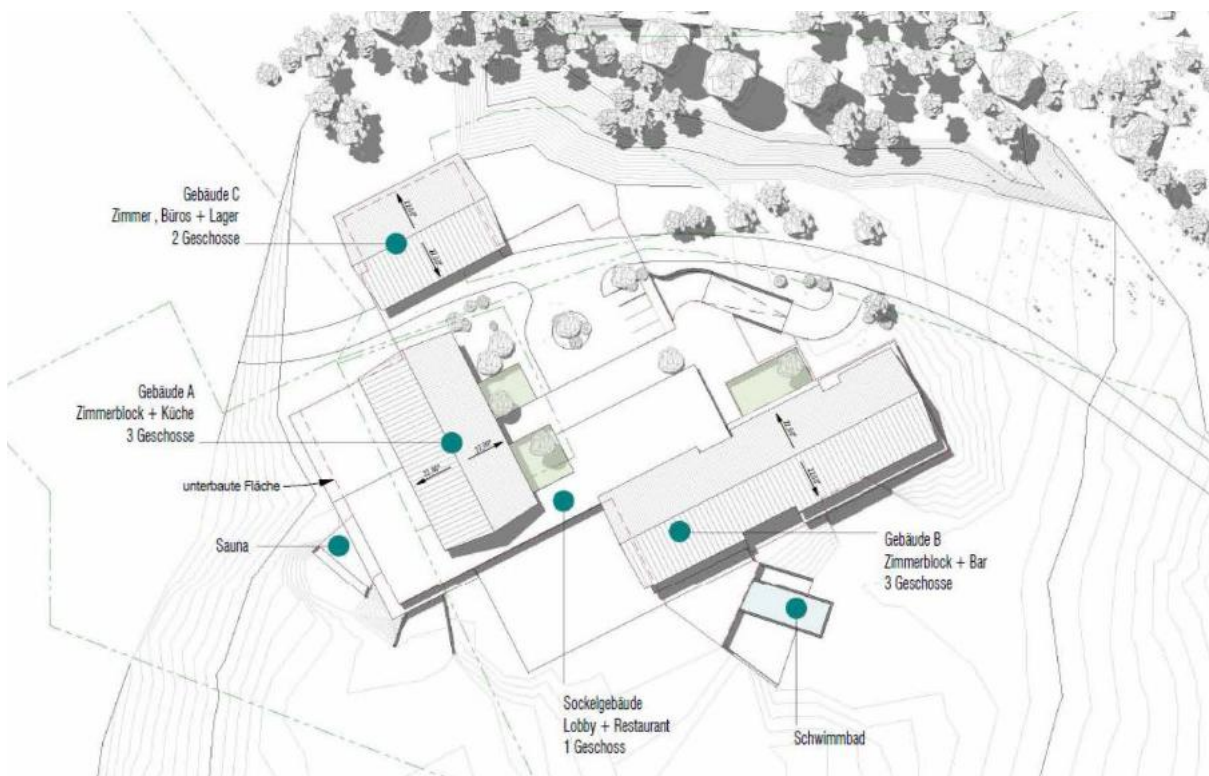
Lageplan geplanter Hotelanlage mit Funktionsbeschreibung; aus [15]
